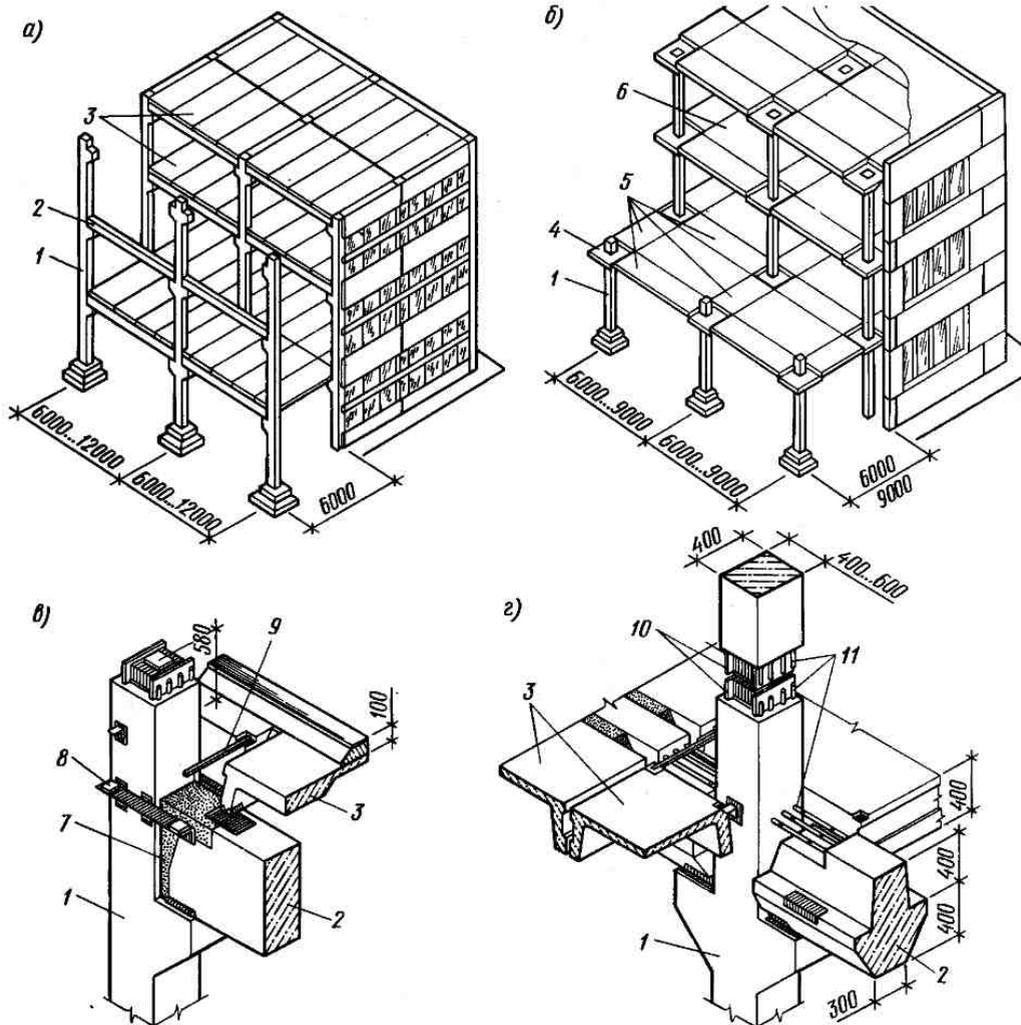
Конструкции перекрытий многоэтажных промышленных зданий:
